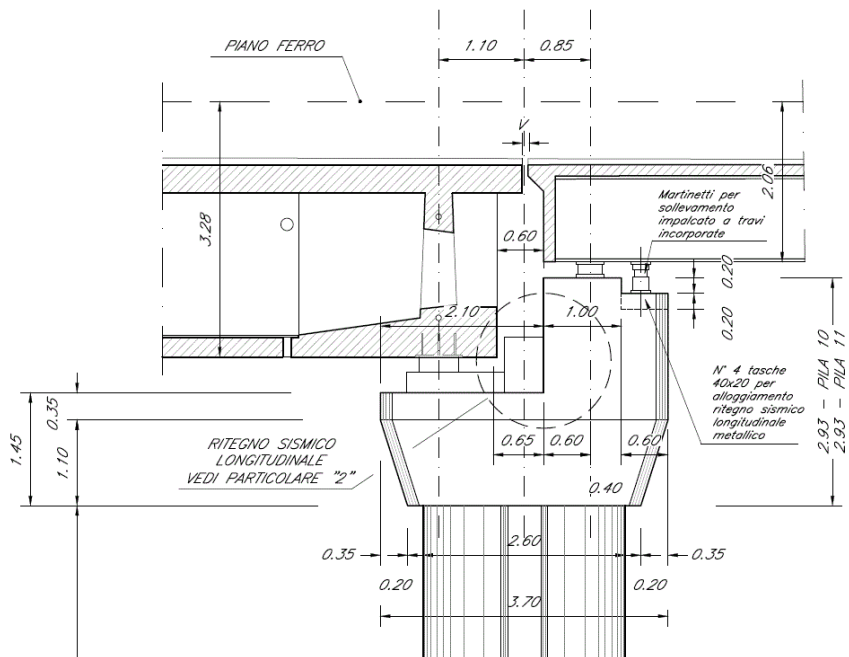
Pila, prospetto longitudinale – Impalcato in CAP ed impalcato a travi incorporate
